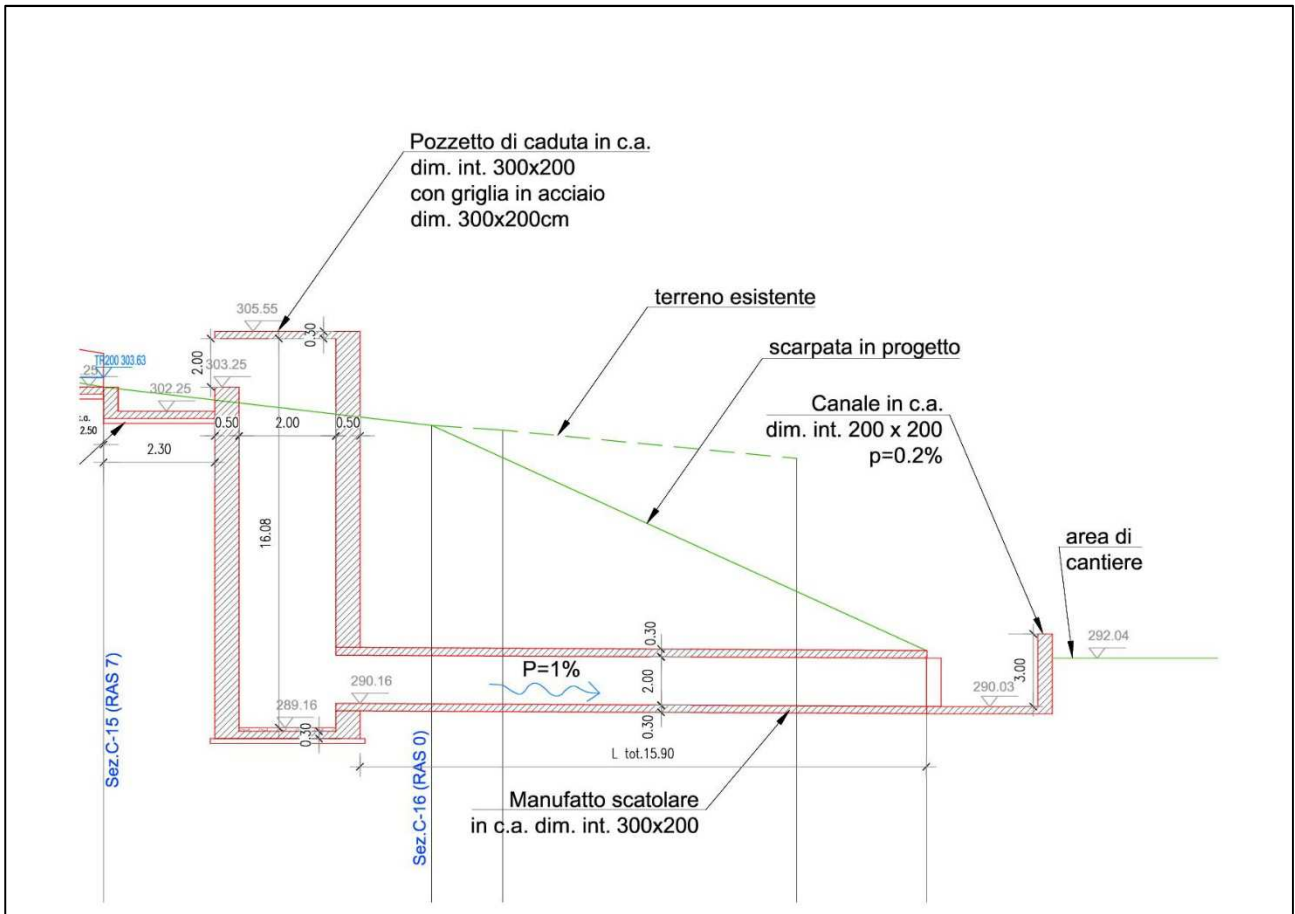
Sistemazione Incisione C – Sezione longitudinale – Tratto immediatamente a monte cantiere
